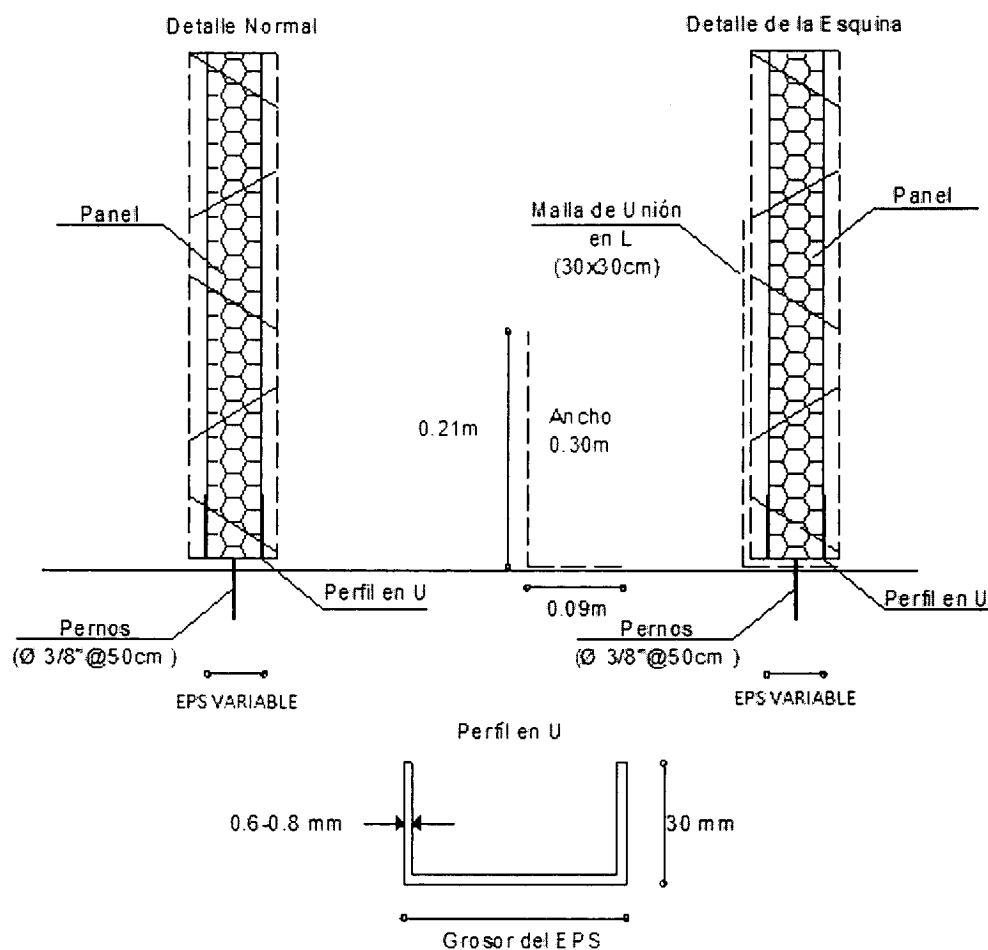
Conexión de la cimentación y el muro interior mediante perfiles en U.
